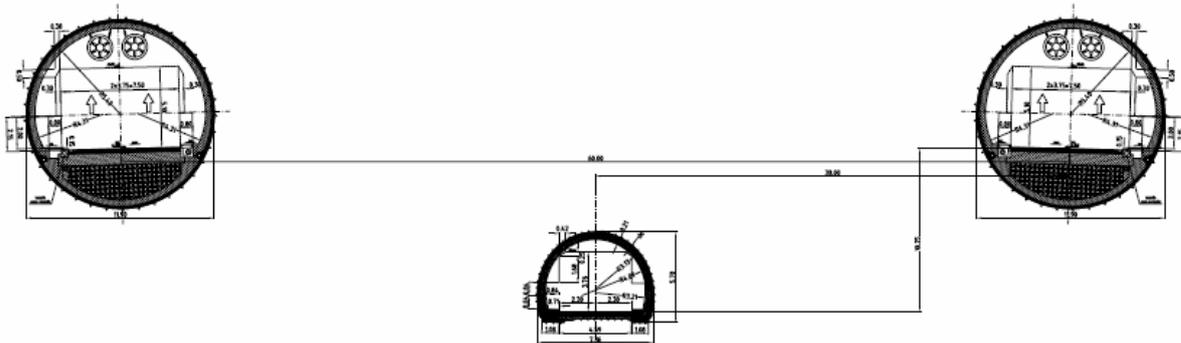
Corte transversal del Túnel en sector con excavación con máquina tunelera
